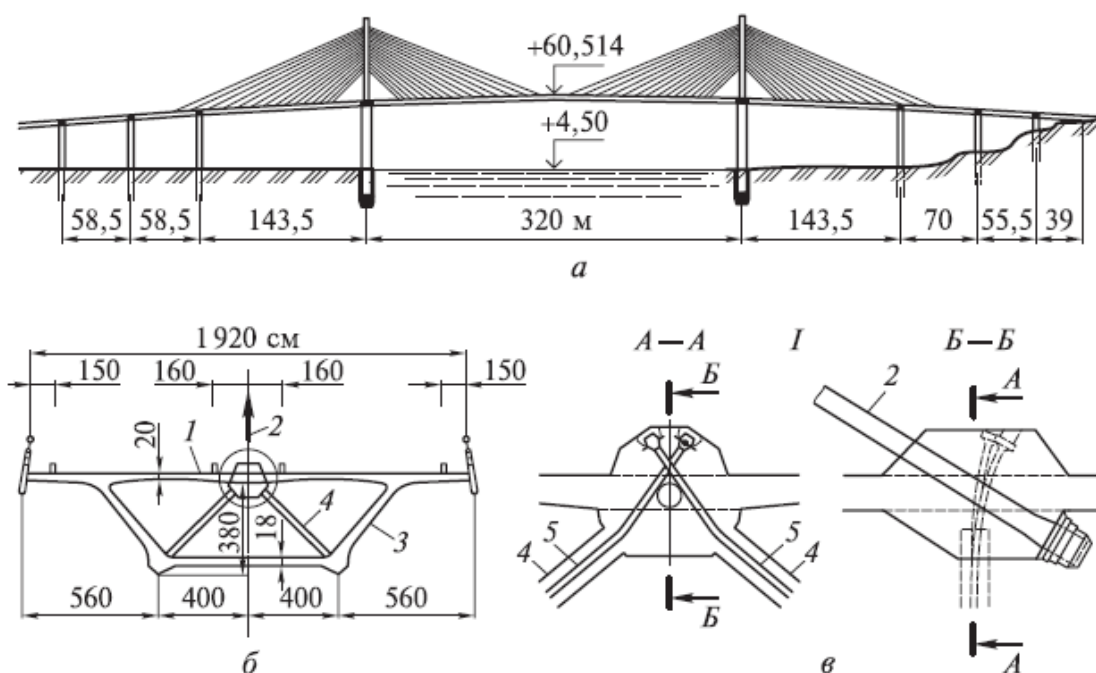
Схема (а) моста Броттон и поперечное сечение (б) его балки жесткости и узел крепления ванты (в):
